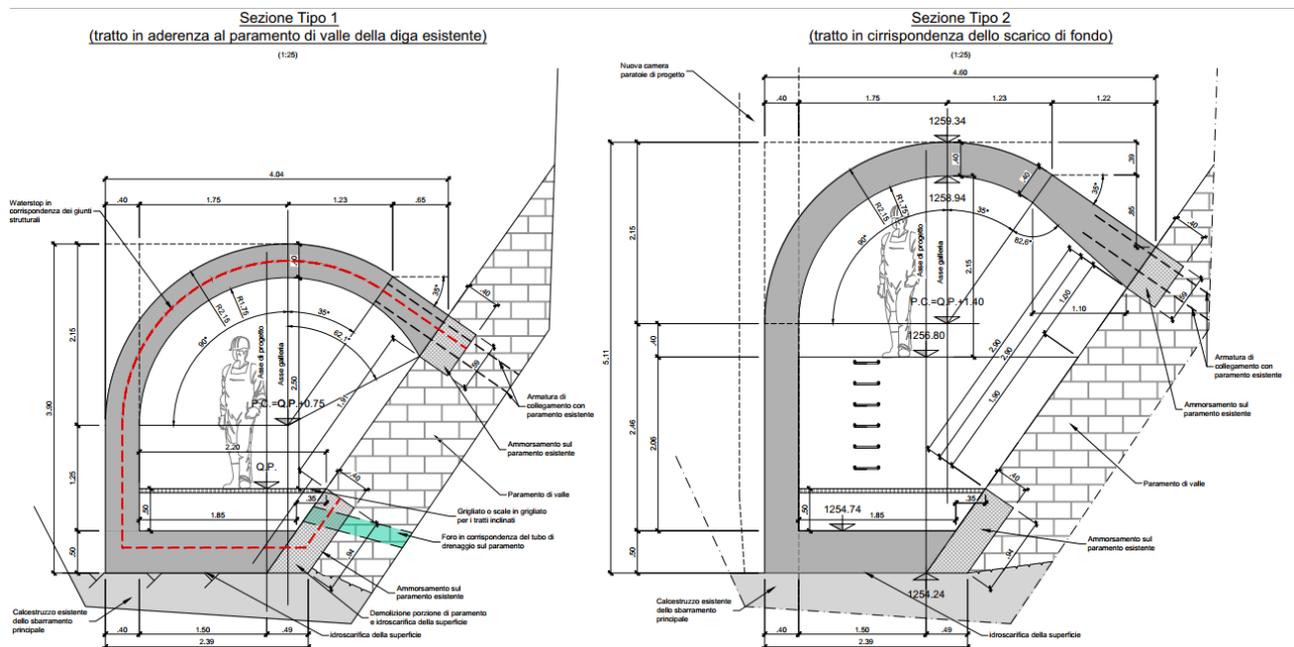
nuovo cunicolo di ispezione e drenaggio, sezione tipologiche 1 e 2
